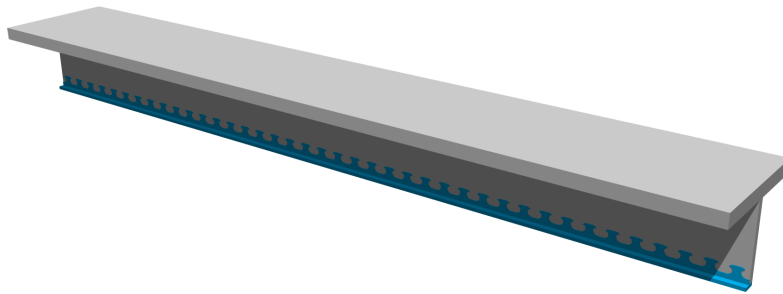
Dreidimensionale Darstellung eines Plattenbalkens mit externer Bewehrung und mittig geschnittenem Steg
